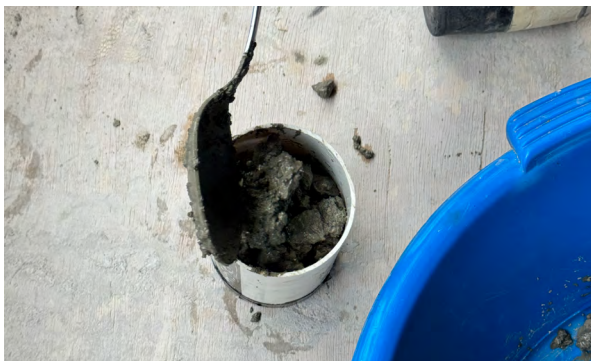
Llenado del molde cilíndrico con la mezcla fresca.
